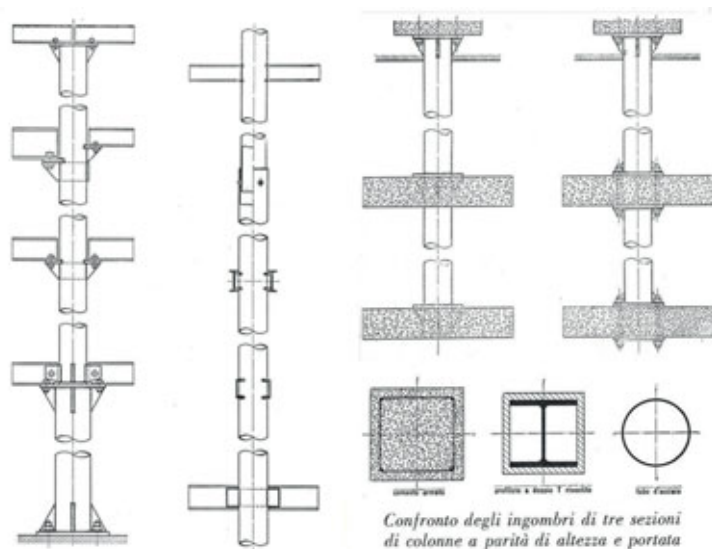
Prima fase operativa del Centro Carpenteria Dalmine (1952-1960): la proposta di collegamenti utili a favorire l'impiego delle colonne tubolari (Fondazione Dalmine).
